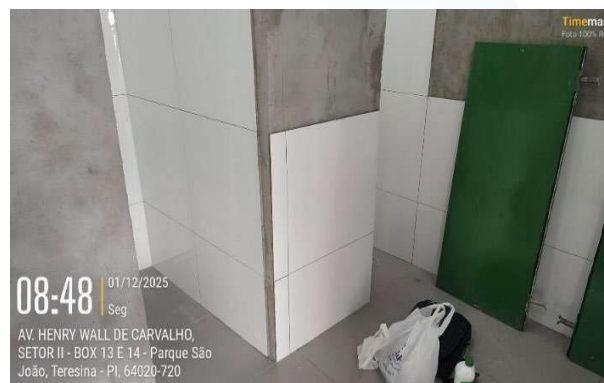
Assentamento de revestimentos cerâmicos sobre contrapiso e parede em banheiro.
